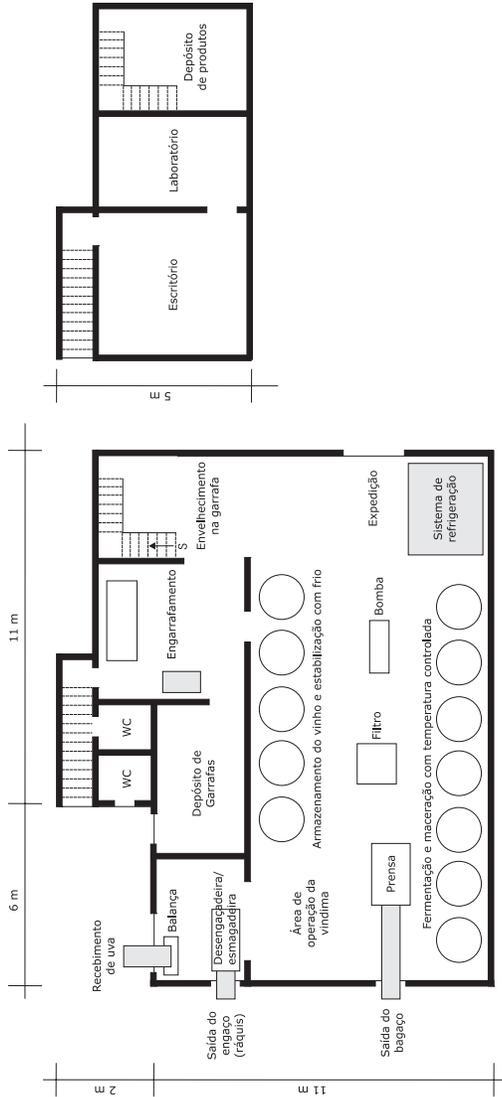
Planta baixa da agroindústria (cantina) para elaboração de vinho.
